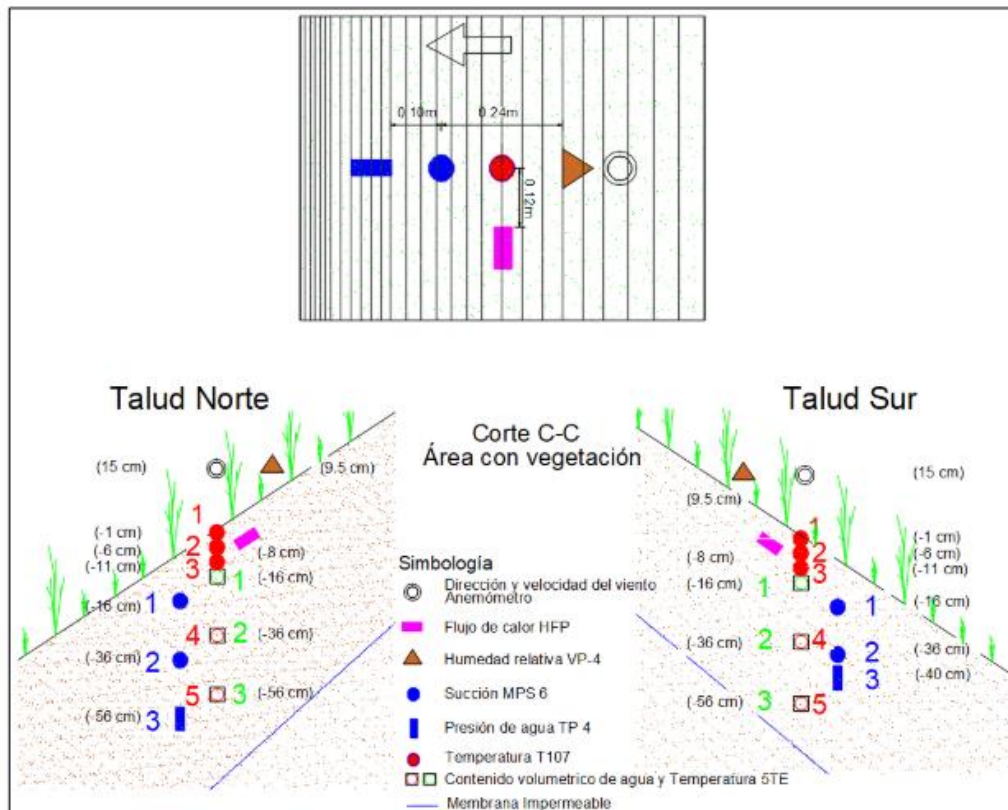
Detalle en planta y perfil, lado vegetado del terraplén (Guachizaca Contenido, 2018)
